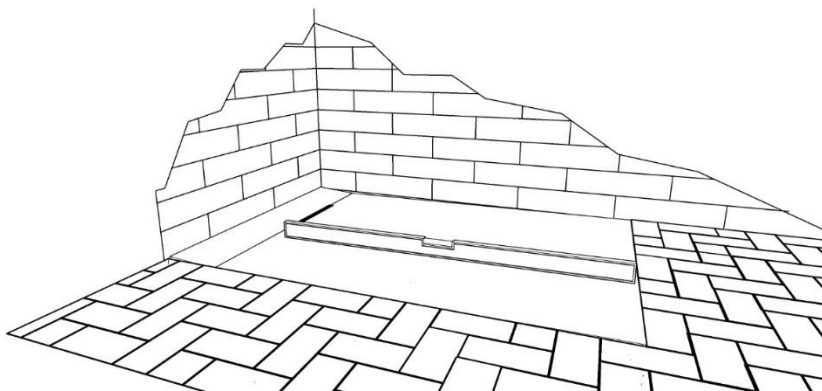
Comprobar el correcto desnivel del canal de drenaje.
